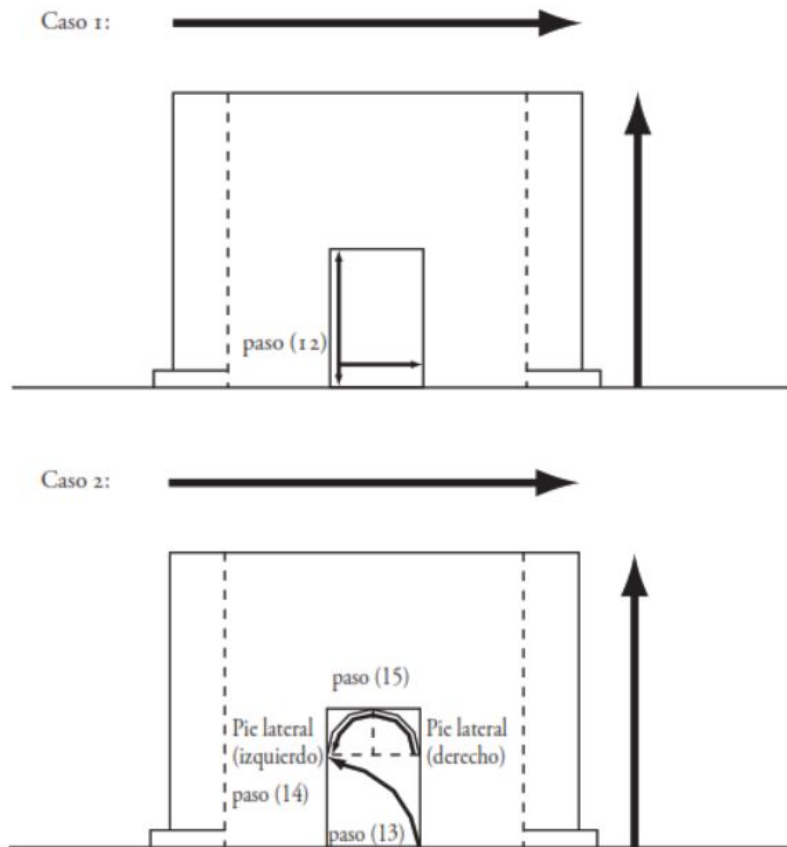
Disposiciones para la construcción, tipologías en muros. Tomado de (Ruiz, 2007)
